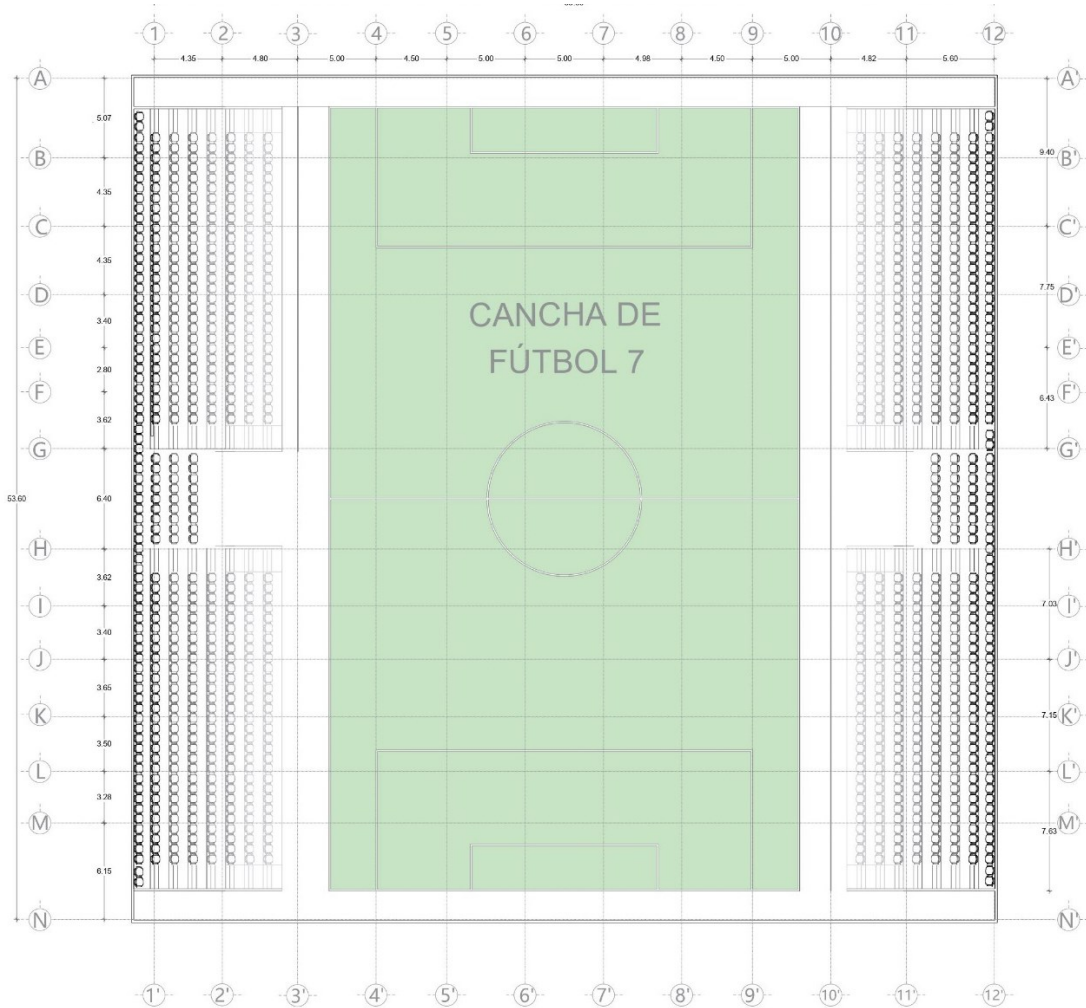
Planta Arquitectónica volumen de Fútbol segundo nivel
